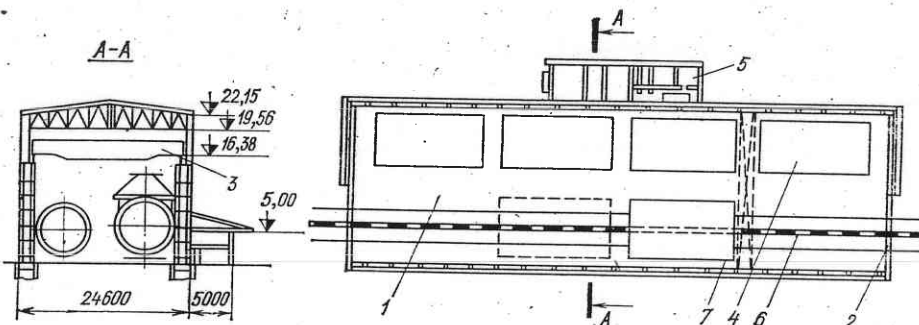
Цех сварки звеньев турбинных водоводов I типа:
